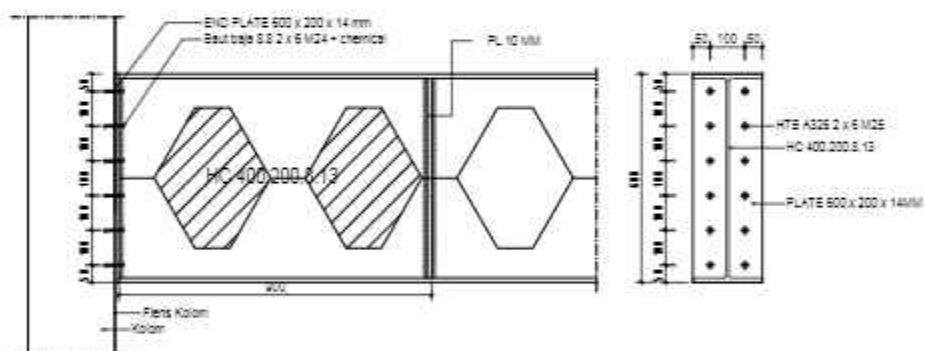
DETAIL HUB. BALOK IWF 600 KE KOLOM BETON (1)
